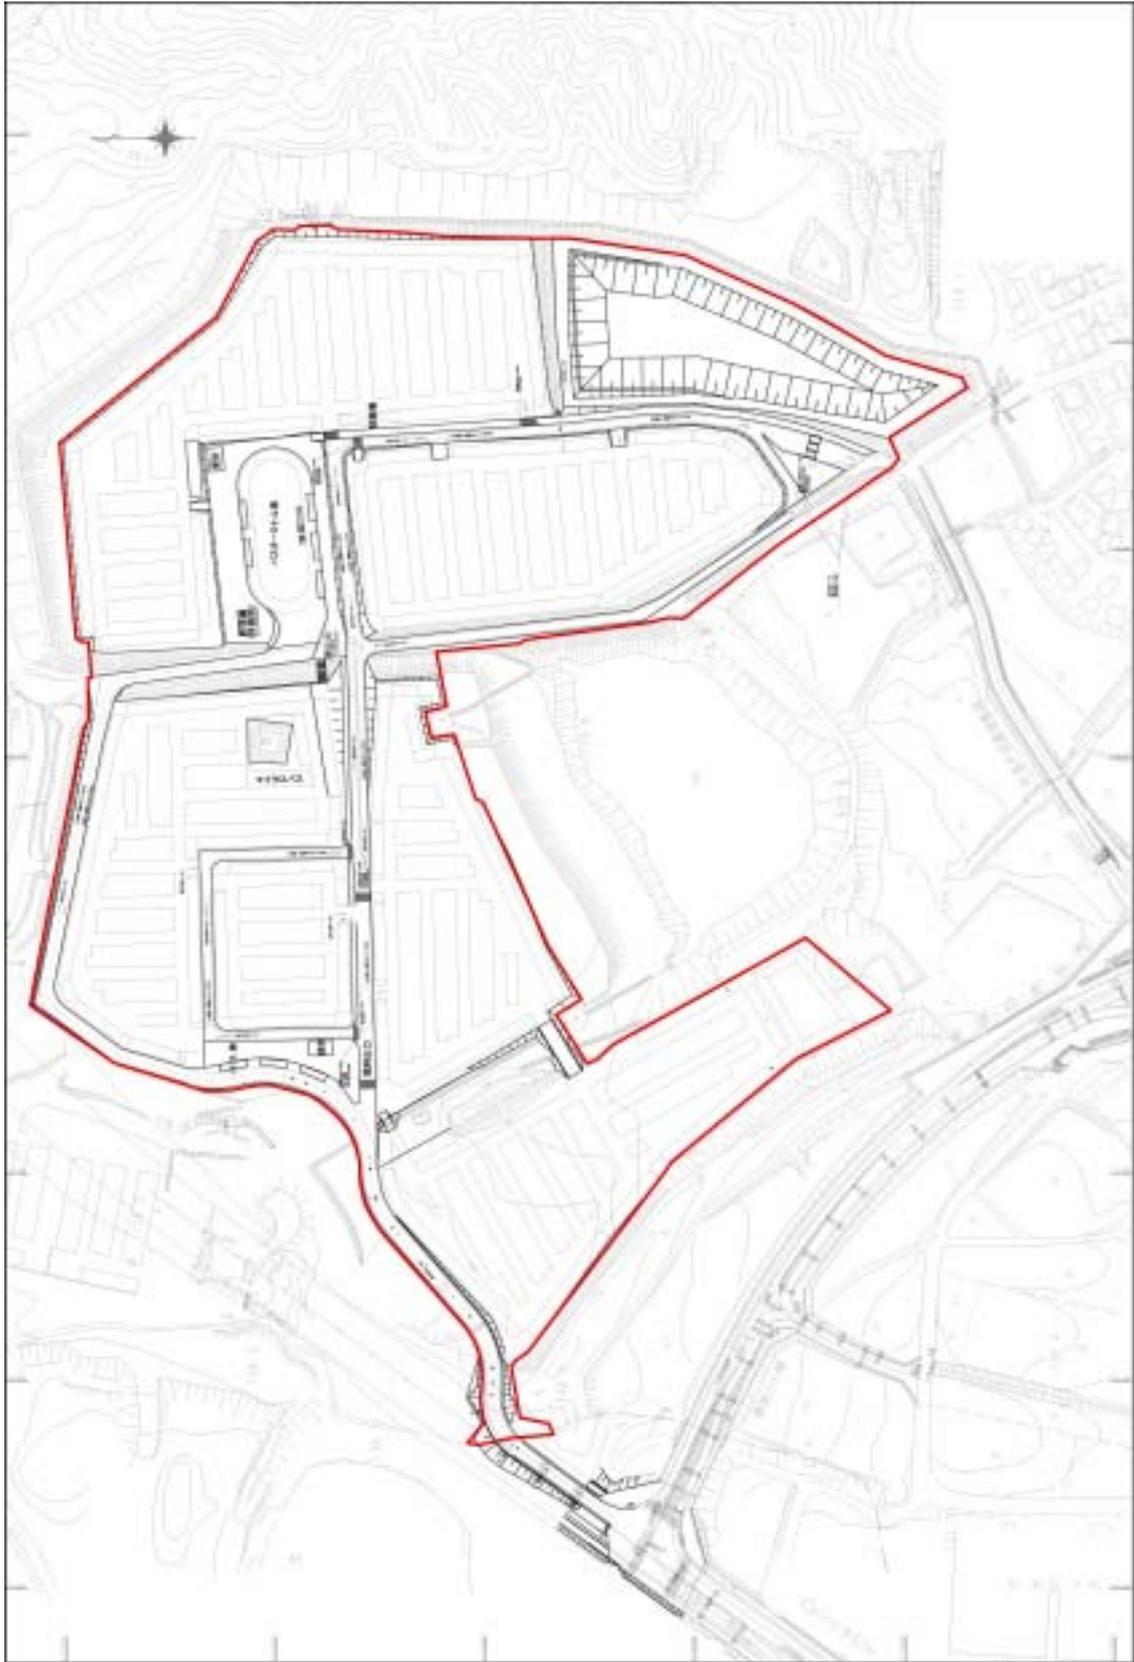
(5) 自家用車駐車場の計画平面図（藤岡インター駐車場）
